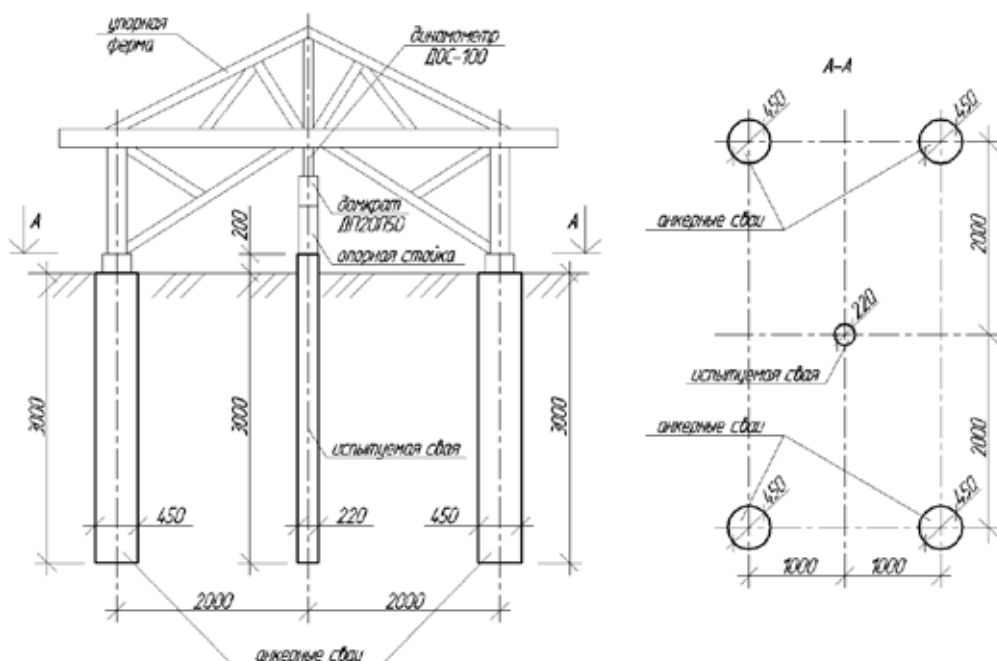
Схема установки для испытания свай осевой статической вдавливающей нагрузкой
